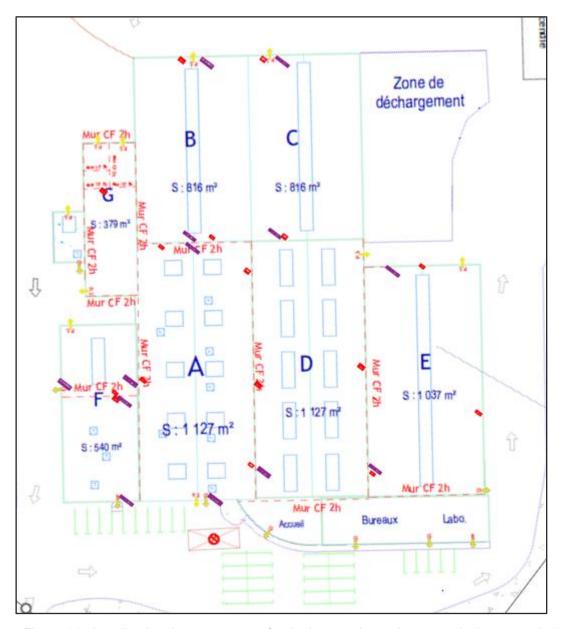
Localisation des murs coupe-feu bâtiment existant (source : sicabconstruction)
